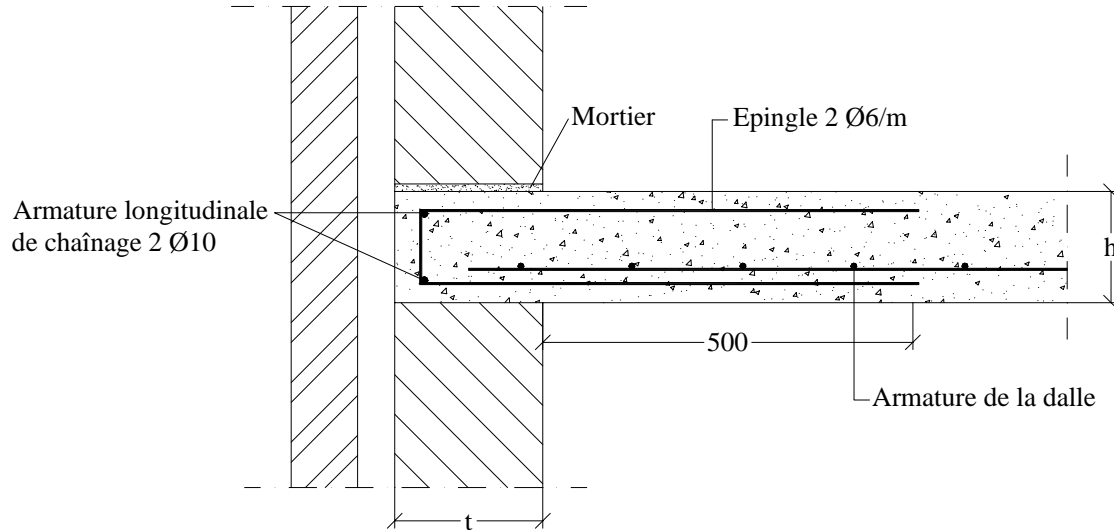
Liaison entre un plancher en dalle de béton coulé sur place et un mur d'appui. Cas du mur à coulisse.
